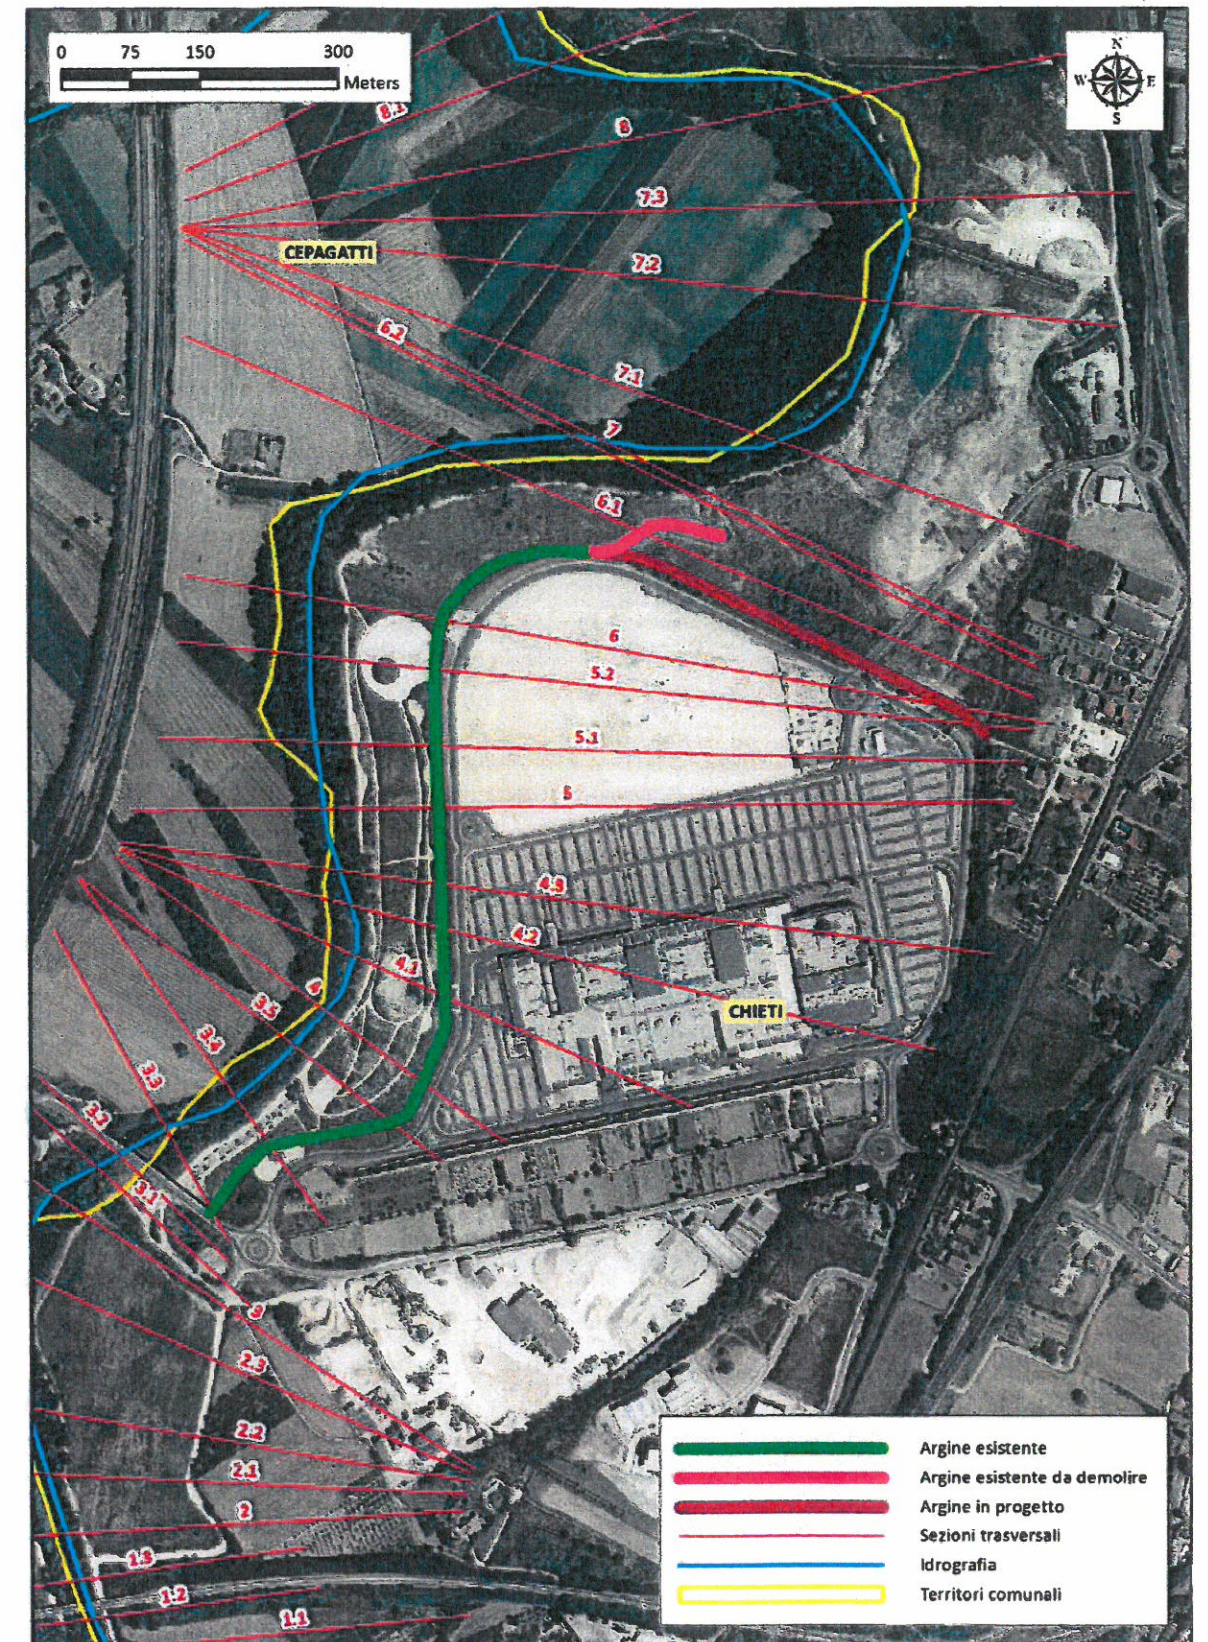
Planimetria dell'area di interesse con l'indicazione degli interventi in progetto su base ortofoto
